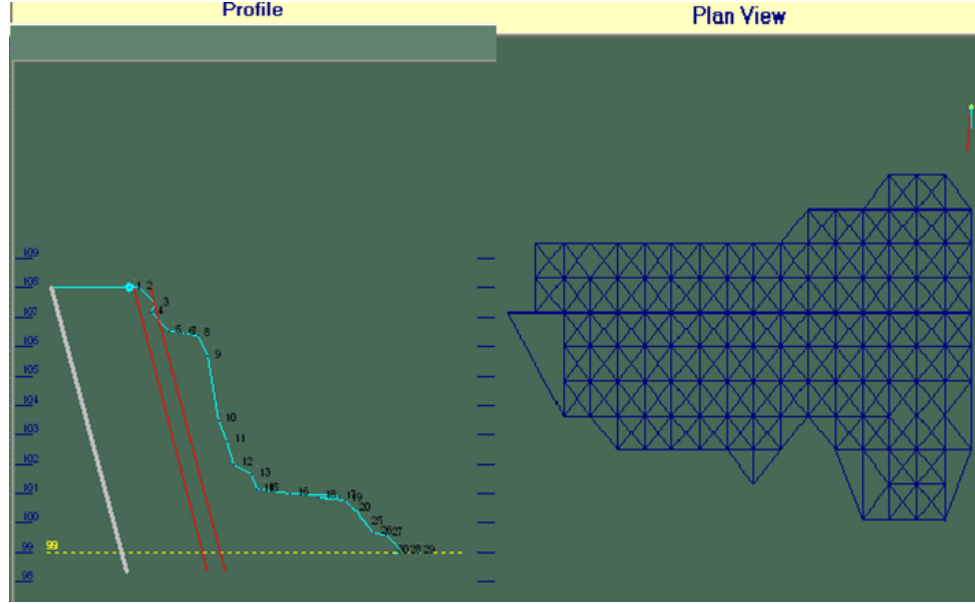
Cebeci sahası delik profili ve plan görünümü (ayna'nın orta kısmı 6. delik)
